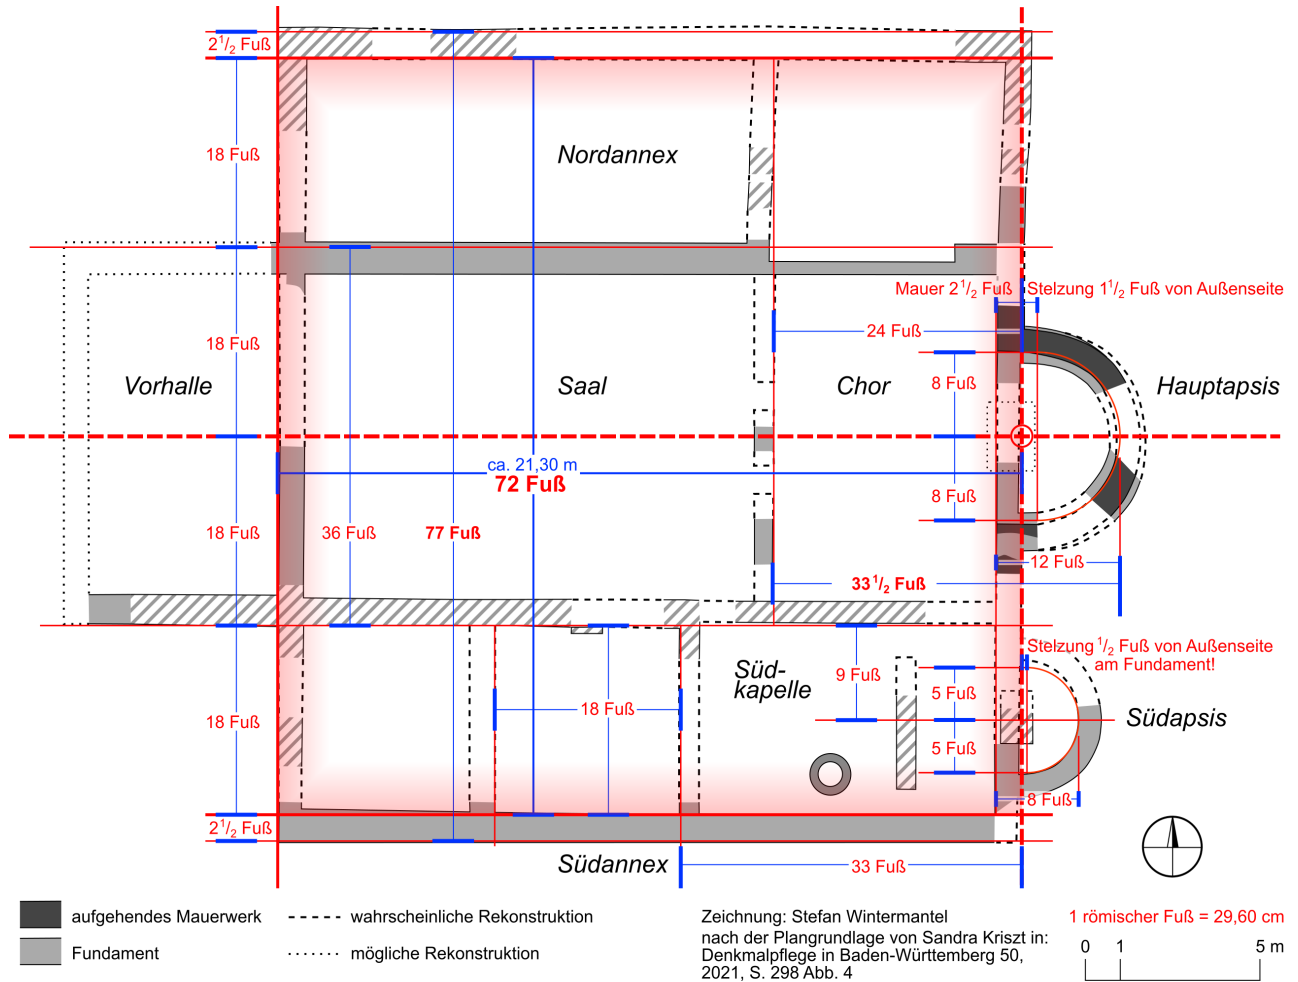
Reichenau-Niederzell: der Grundriss der Kirche Eginos (Bau II)
